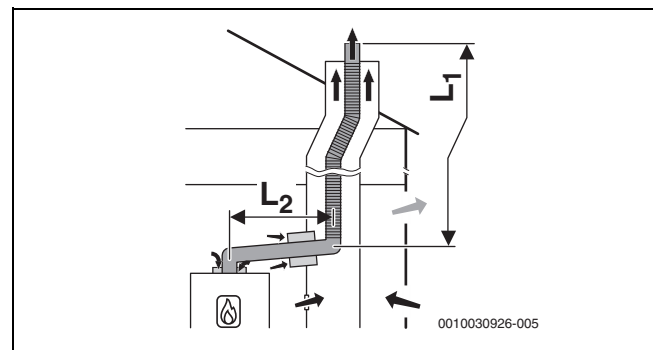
Évacuation des fumées flexible dans le conduit selon B_{53p} avec alimentation d'air dépendant de l'air ambiant sur l'appareil ; ouverture de ventilation dans le conduit
